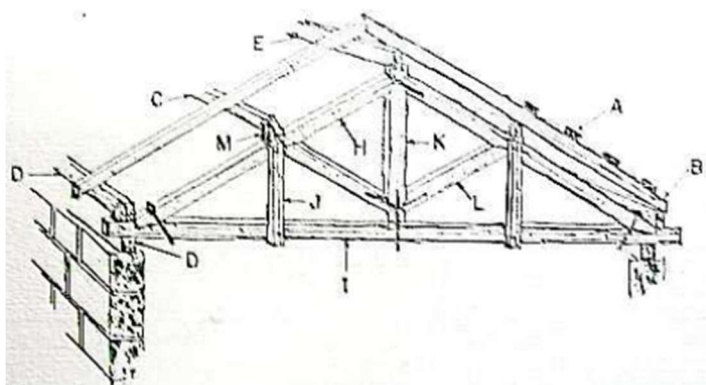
Elementos estruturais componentes dos telhados coloniais.
